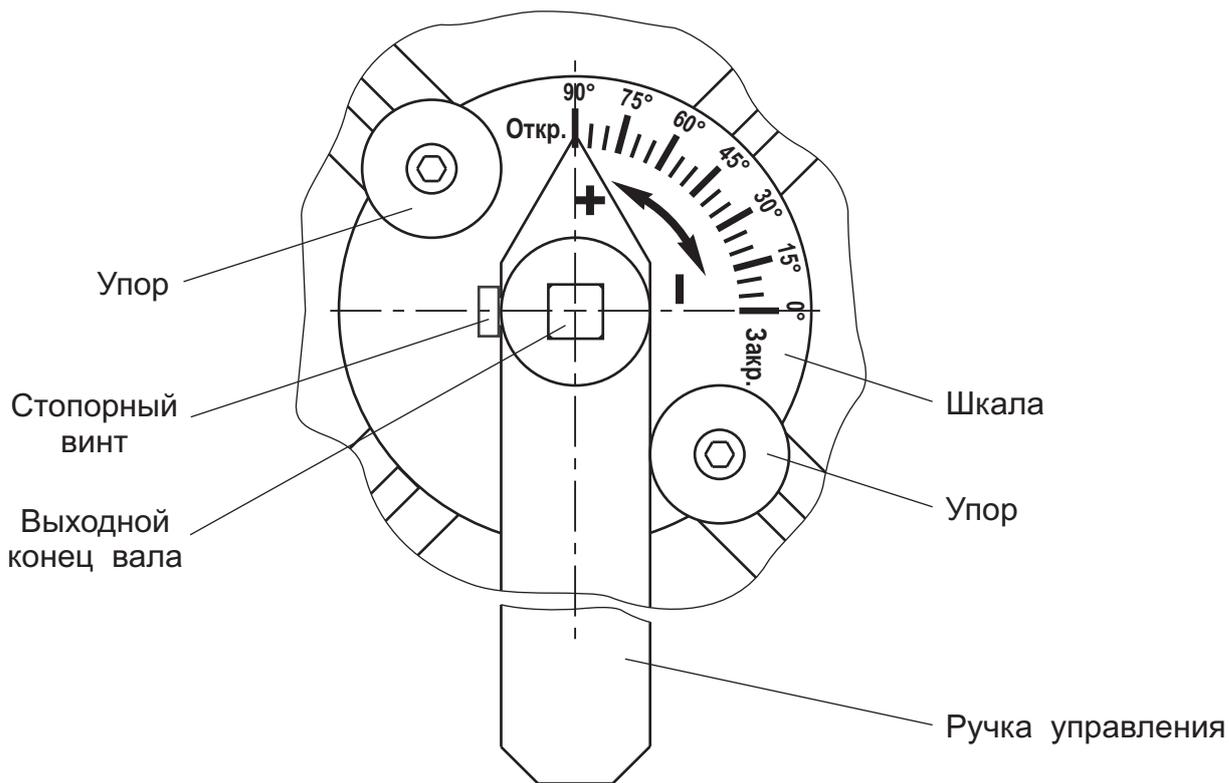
Заслонка регулирующая с ручным управлением (вид сверху)
